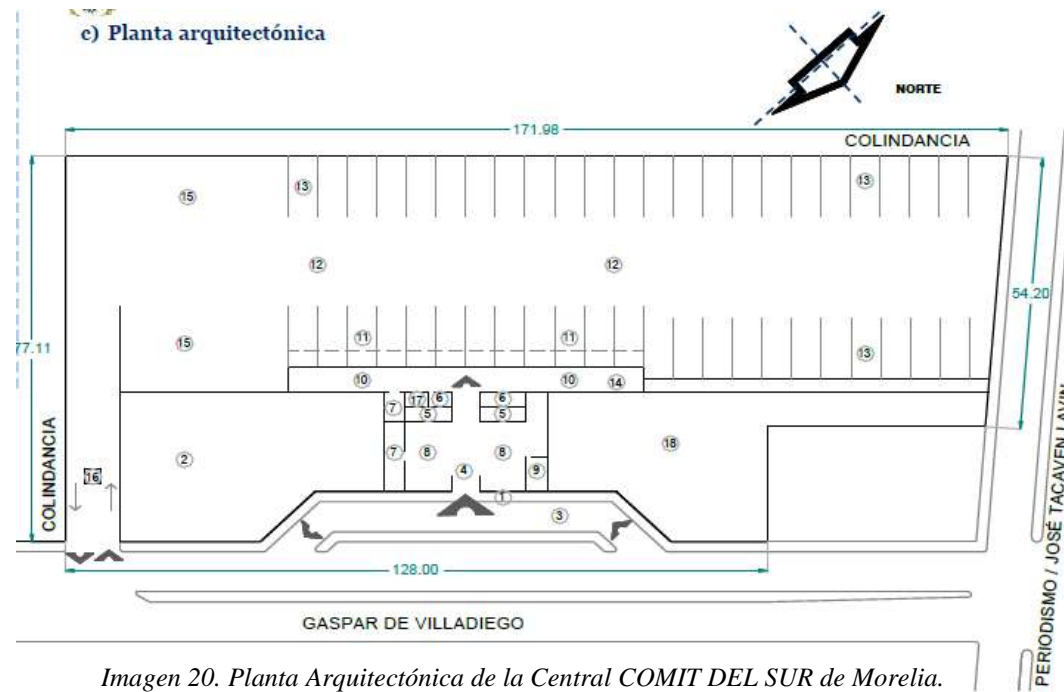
Planta Arquitectónica de la Central COMIT DEL SUR de Morelia.
